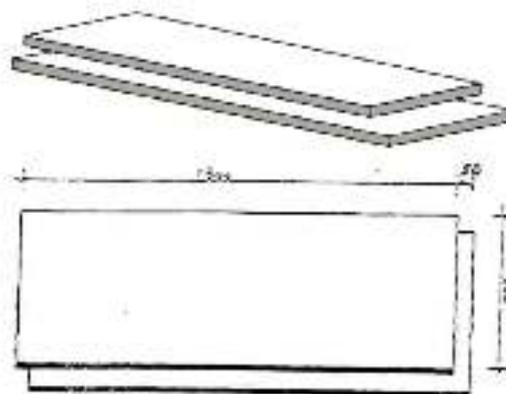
Plaque Fermacell issu du DTA-13/14 -1252
